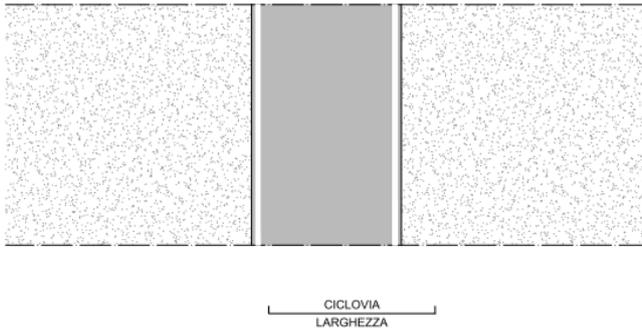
Individuazione planimetrica dei tratti con interventi di progetto
